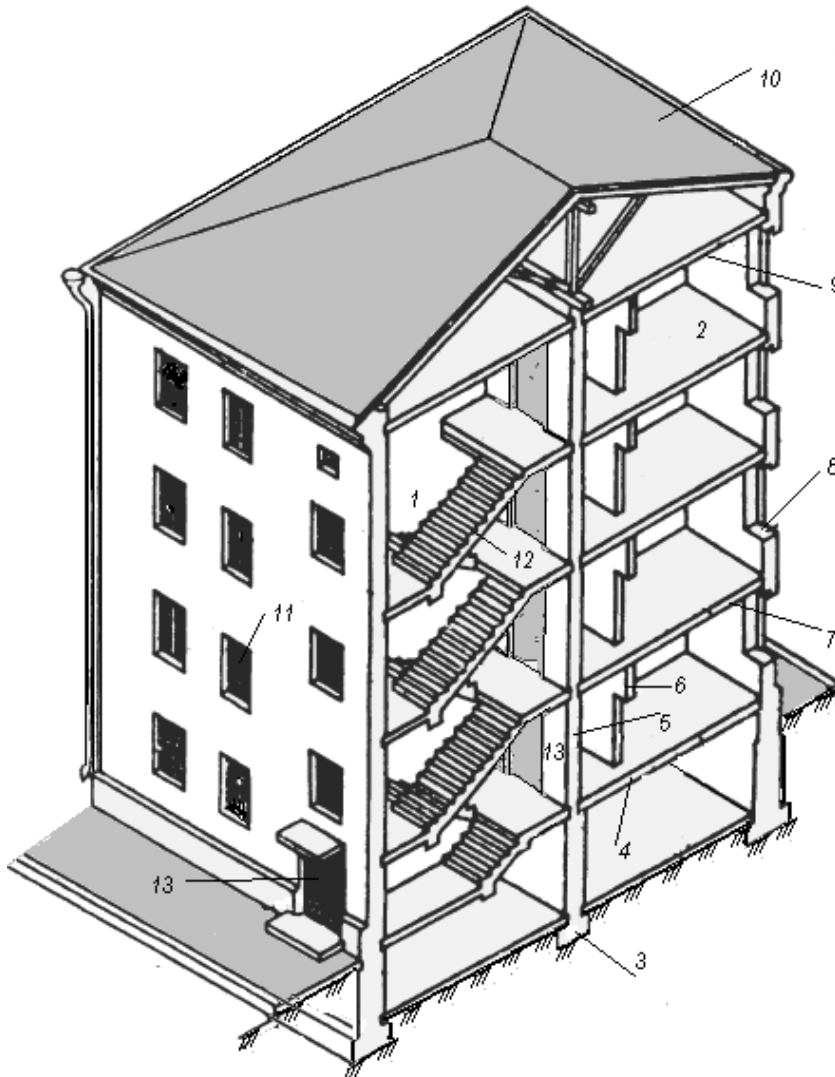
Об'ємно-планувальні і конструктивні елементи будівлі: 1 – сходові клітки; 2 – кімната; 3 – фундамент; 4 – перекриття над підвалом; 5 – внутрішня стіна; 6 – перегородка; 7 – міжповерхове перекриття; 8 – зовнішня стіна; 9 – горіщне перекриття; 10 – дах; 11 – вікно; 12 – сходи; 13 – двері
